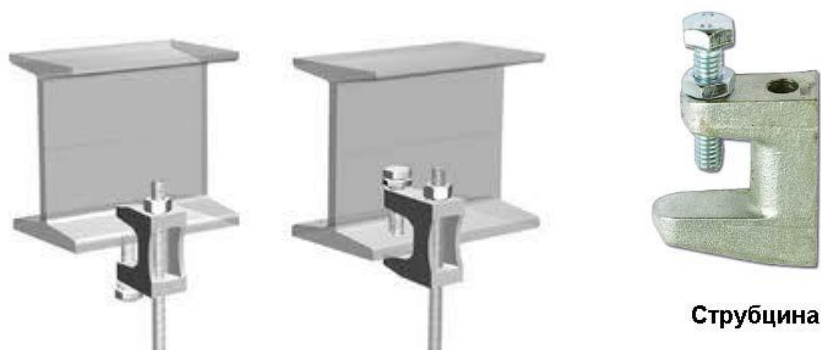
Пример крепления шпильки к балкам с помощью струбцины и шпильки М10
